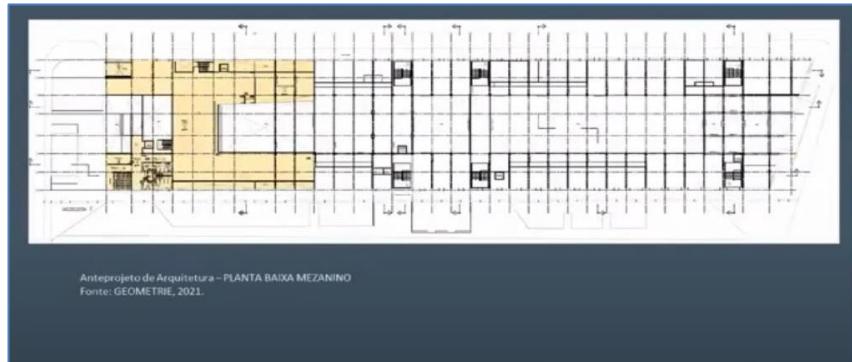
Planta baixa mezanino destinado a reserva técnica do Laau
